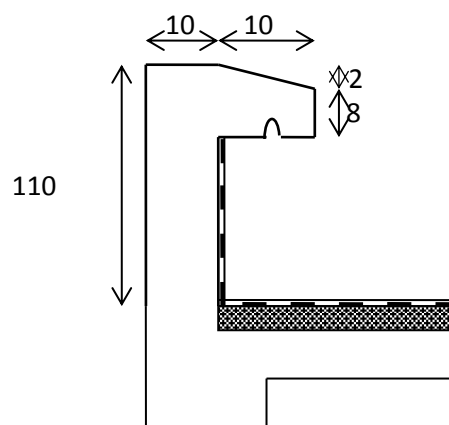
les dimensions d'acrotère pour terrasse accessible.
